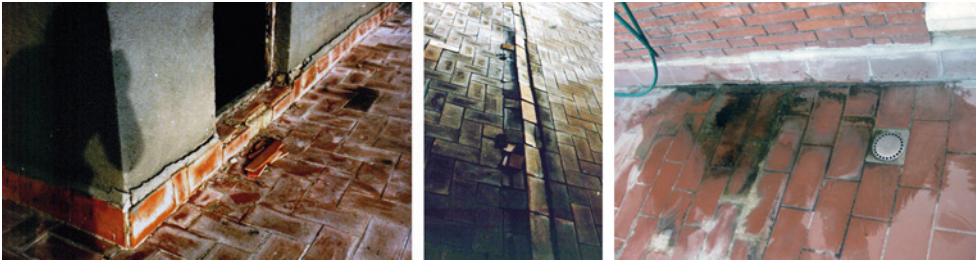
En la foto de la izquierda, ejemplos de mimbel con grieta abierta en la parte superior. En la foto del centro, levantamiento del pavimento en junta de dilatación del edificio. En la foto de la derecha, charco junto a punto de desagüe por incorrección de la pendiente del pavimento en esta zona.
